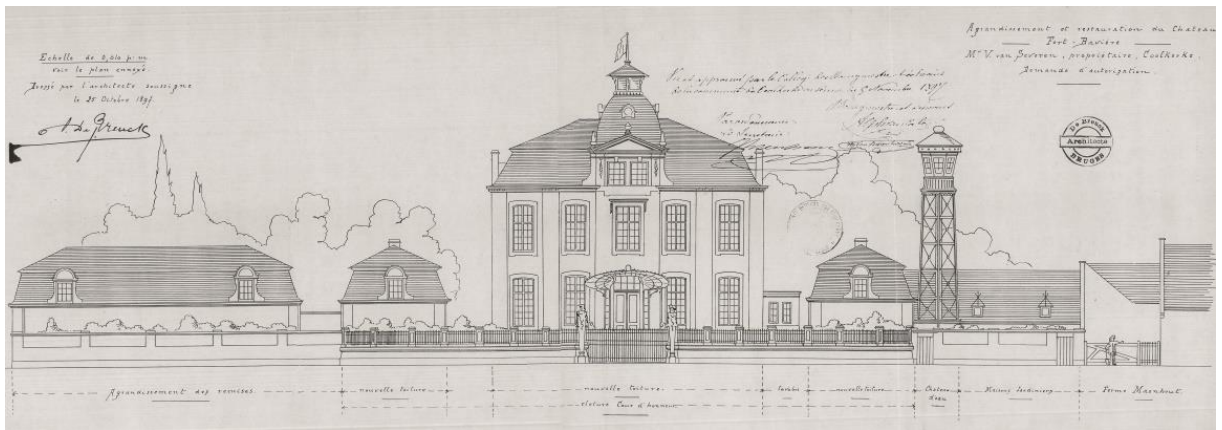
Uitsnede uit de bouwaanvraag uit 1897 (detail kasteelgebouw) (© Jan Desmet).
